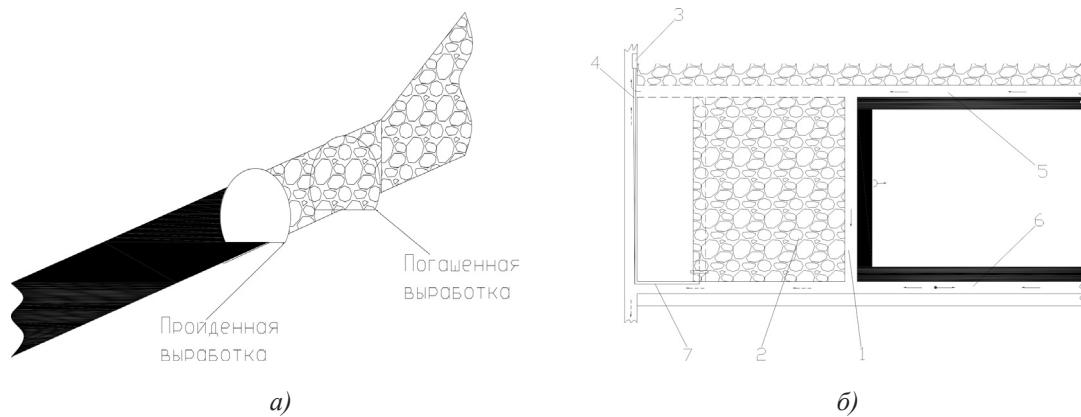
Технологическая схема очистных работ с возвратноточным проветриванием выемочного столба: а – разрез; б – план: 1 – лавы; 2 – выработанное пространство; 3 – камера смещения; 4 – трубопровод для изолированного отвода метана; 5 – вентиляционная выработка; 6 – конвейерная выработка; 7 –дегазационный газопровод
